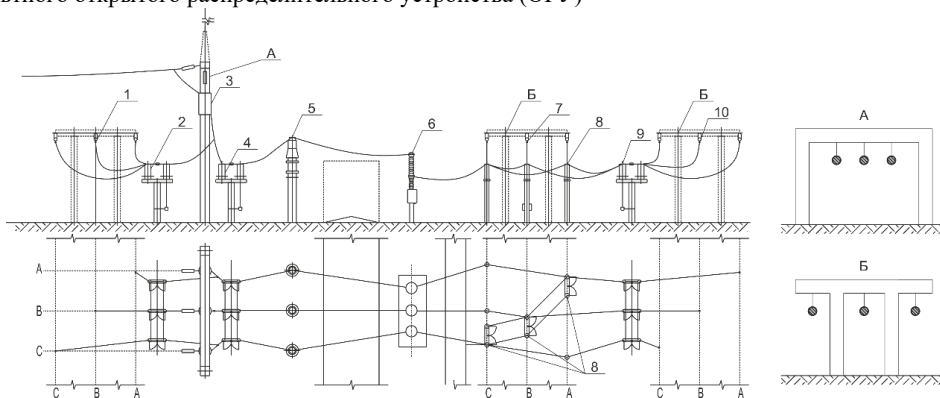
Типовая компоновка ОРУ для схемы с двумя рабочими и обходной системами шин: 1 – обходная СШ; 2 – разъединитель ОСШ; 3 – заградитель; 4 – линейный разъединитель; 5 – трансформатор тока; 6 – выключатель; 7 – первая СШ; 8 – шинные разъединители килевого расположения; 9 – шинные разъединители; 10 – вторая СШ; А – линейные/шинные порталы 110-330 кВ; Б – шинные порталы 110 кВ.
